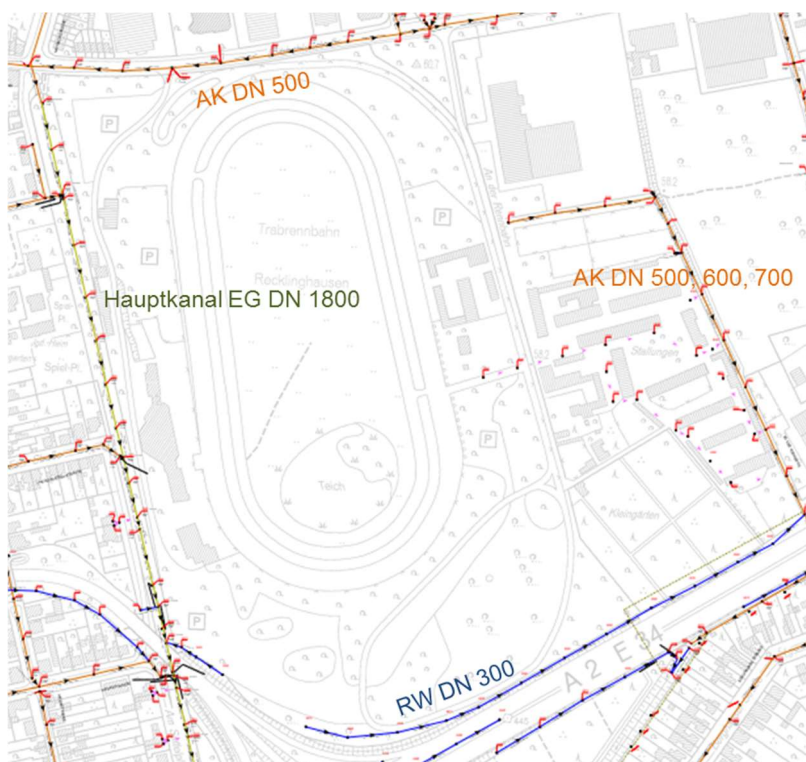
Ausschnitt Lageplan Kanalbestand (zur Verfügung gestellt durch Stadtentwässerung Recklinghausen (Sachgebiet 62/41, Stand: 29.01.2020)
